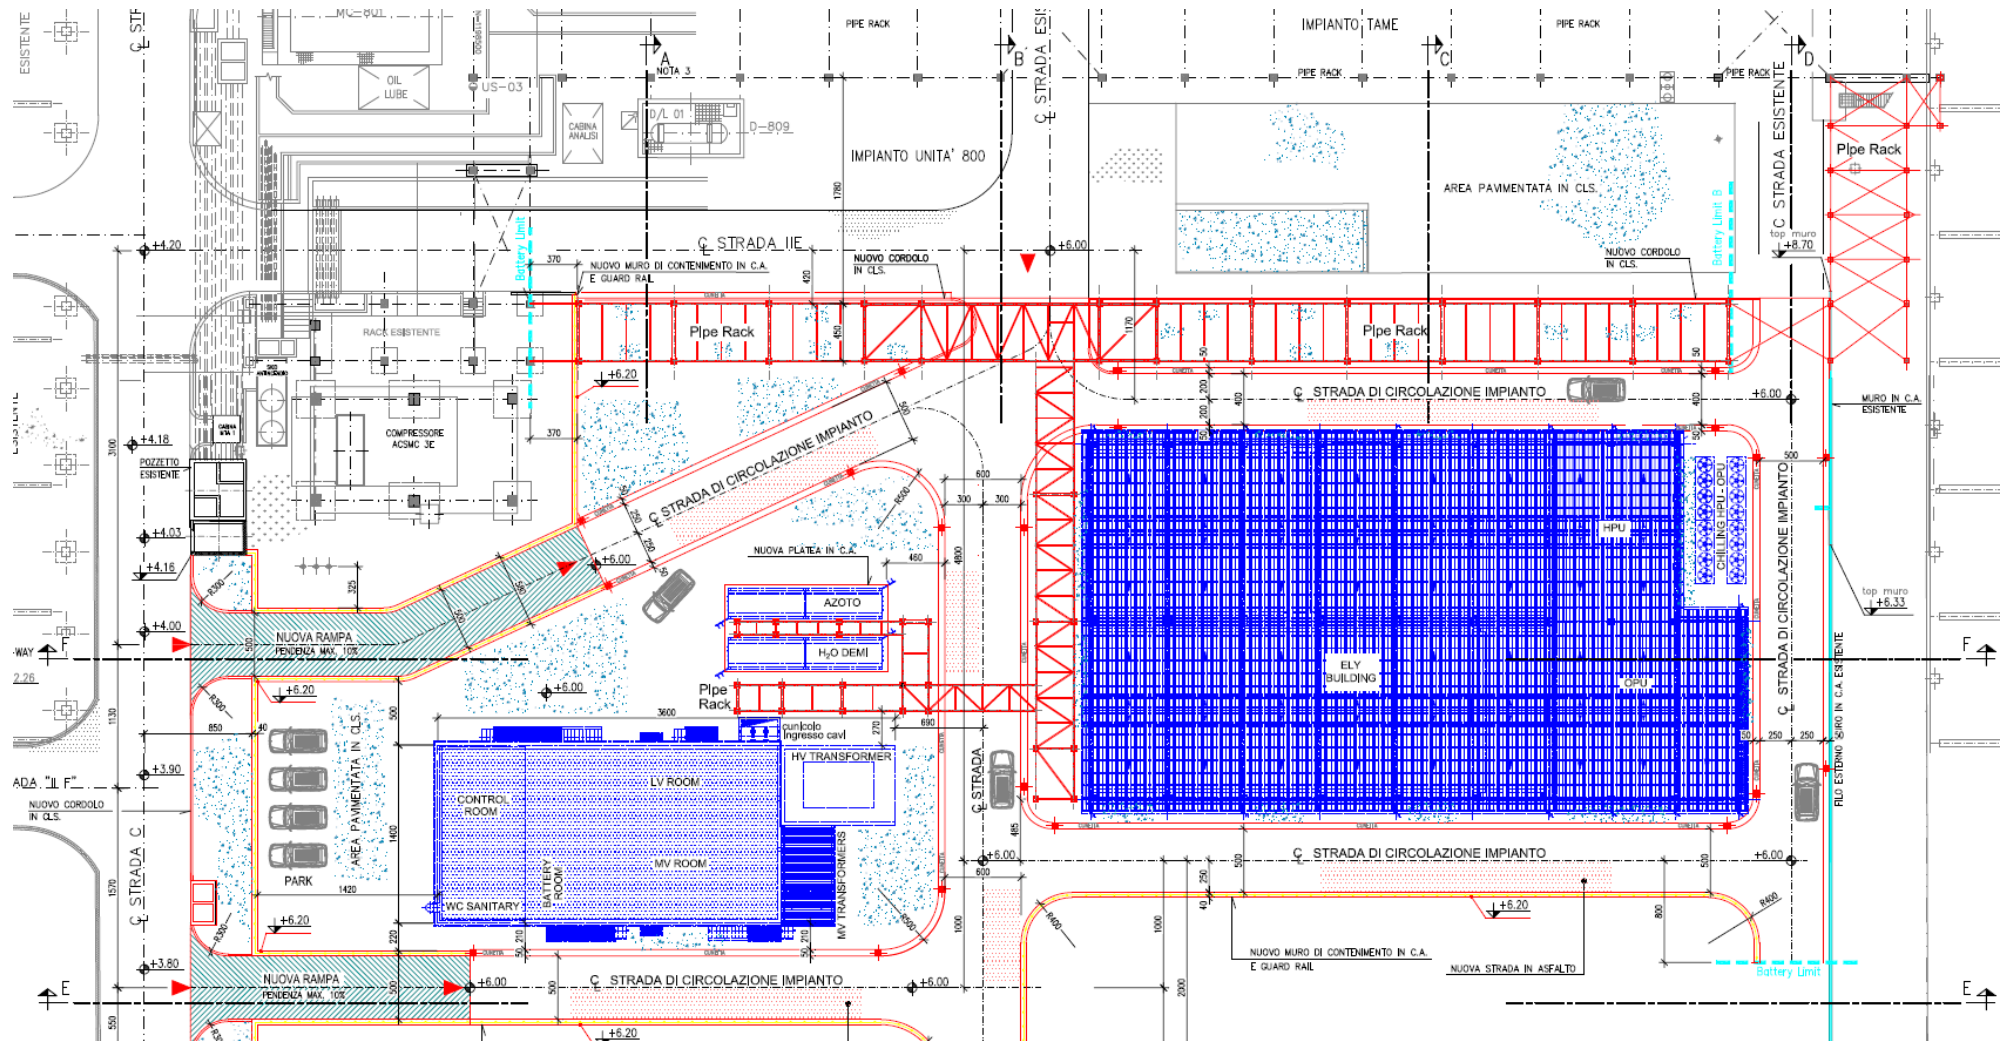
Planimetria stato futuro con indicazione delle sezioni
